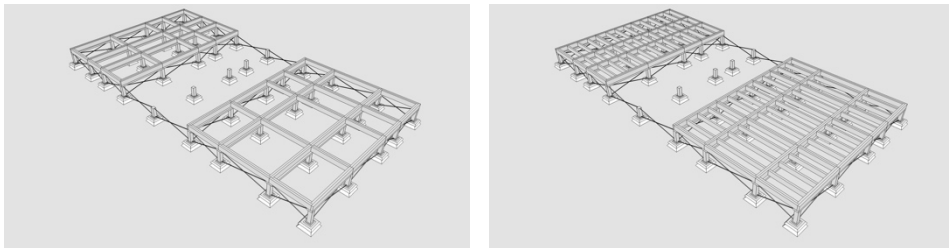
e 50 Execução da armação de pavimento (colocação das vigas e vigotas de pavimento)
